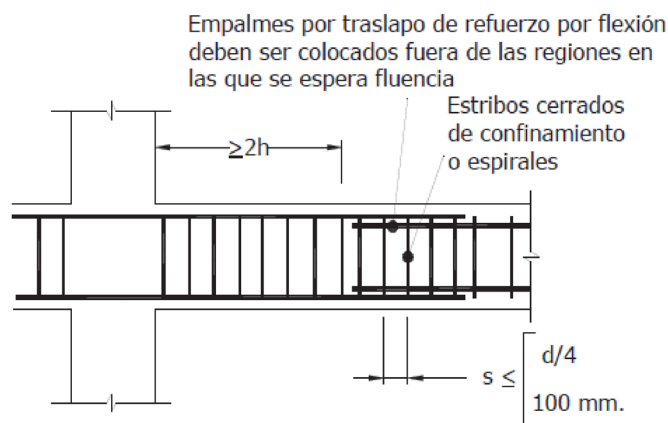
Traslape de varillas de refuerzo longitudinal
